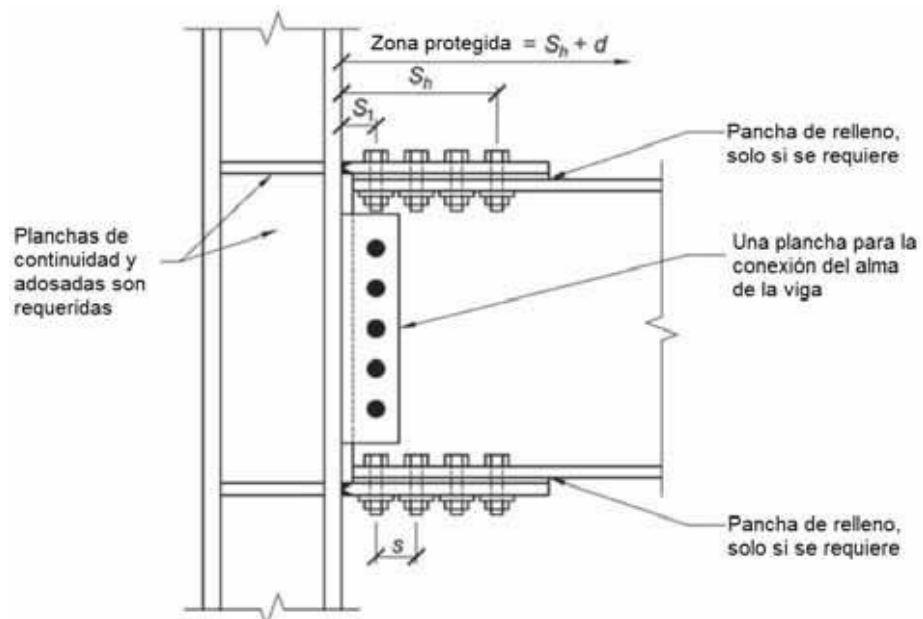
Conexión emperrada a momento con plancha de cubierta en alas
